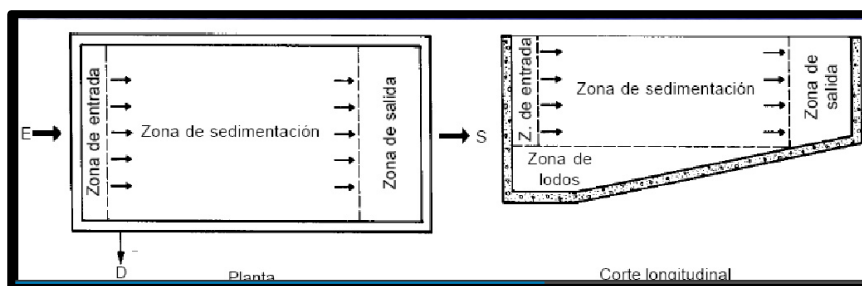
Planta y alzado de un sedimentador convencional.
